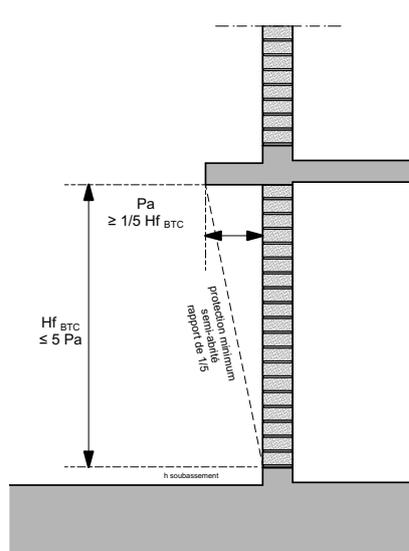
FAÇADE ABRITÉE, PRINCIPE SCHÉMATIQUE DE LA PROFONDEUR DE L'ABRI - DÉBORD DE TOITURE, BALCON ET LOGGIA
